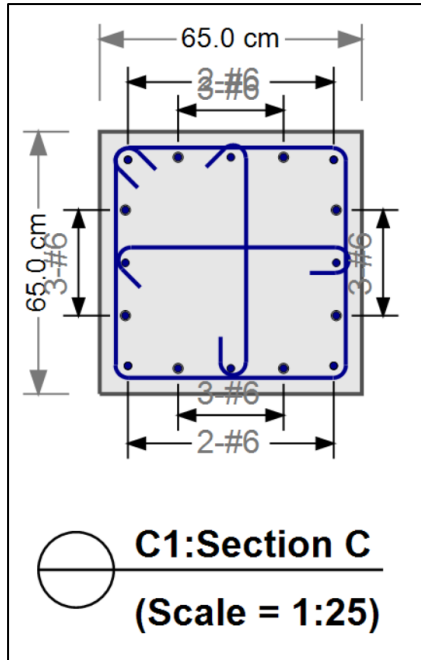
Detallado de acero en columnas típicas niveles 4-7
